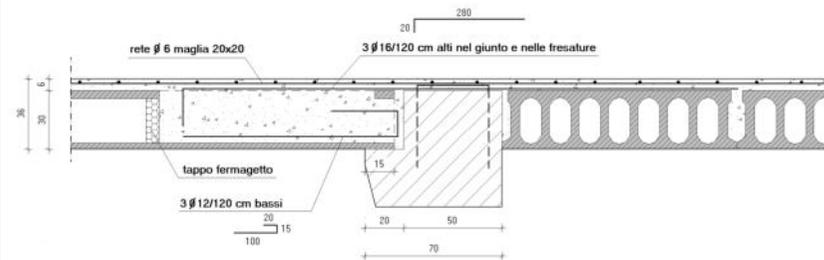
Esempio di collegamento con trave centrale di impalcato a diversa orditura
